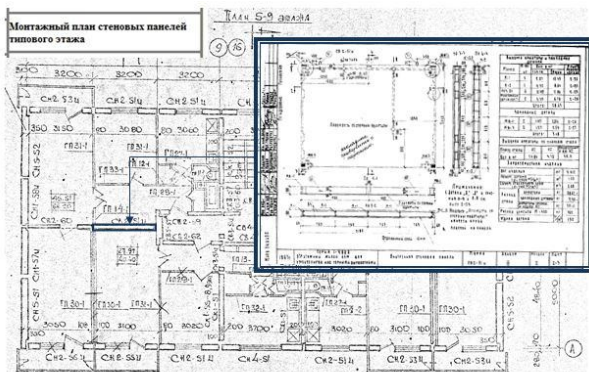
Монтажный план стеновых панелей типового этажа / *Mounting plan of wall panels of standard floor
